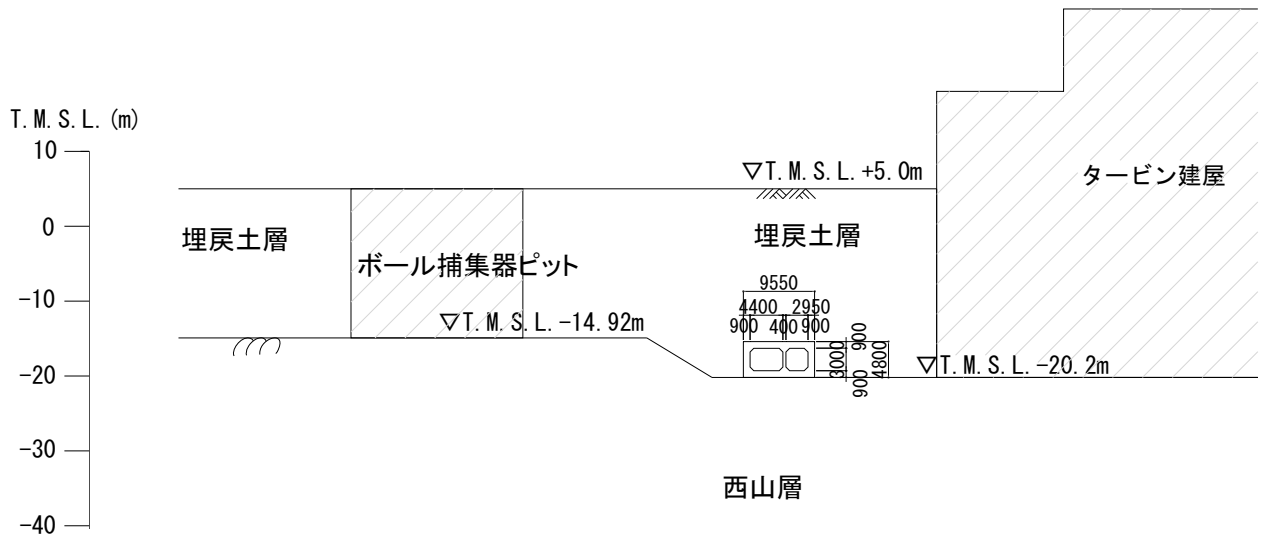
原子炉補機冷却系配管ダクト (B系) 断面図 (C-C 断面)
